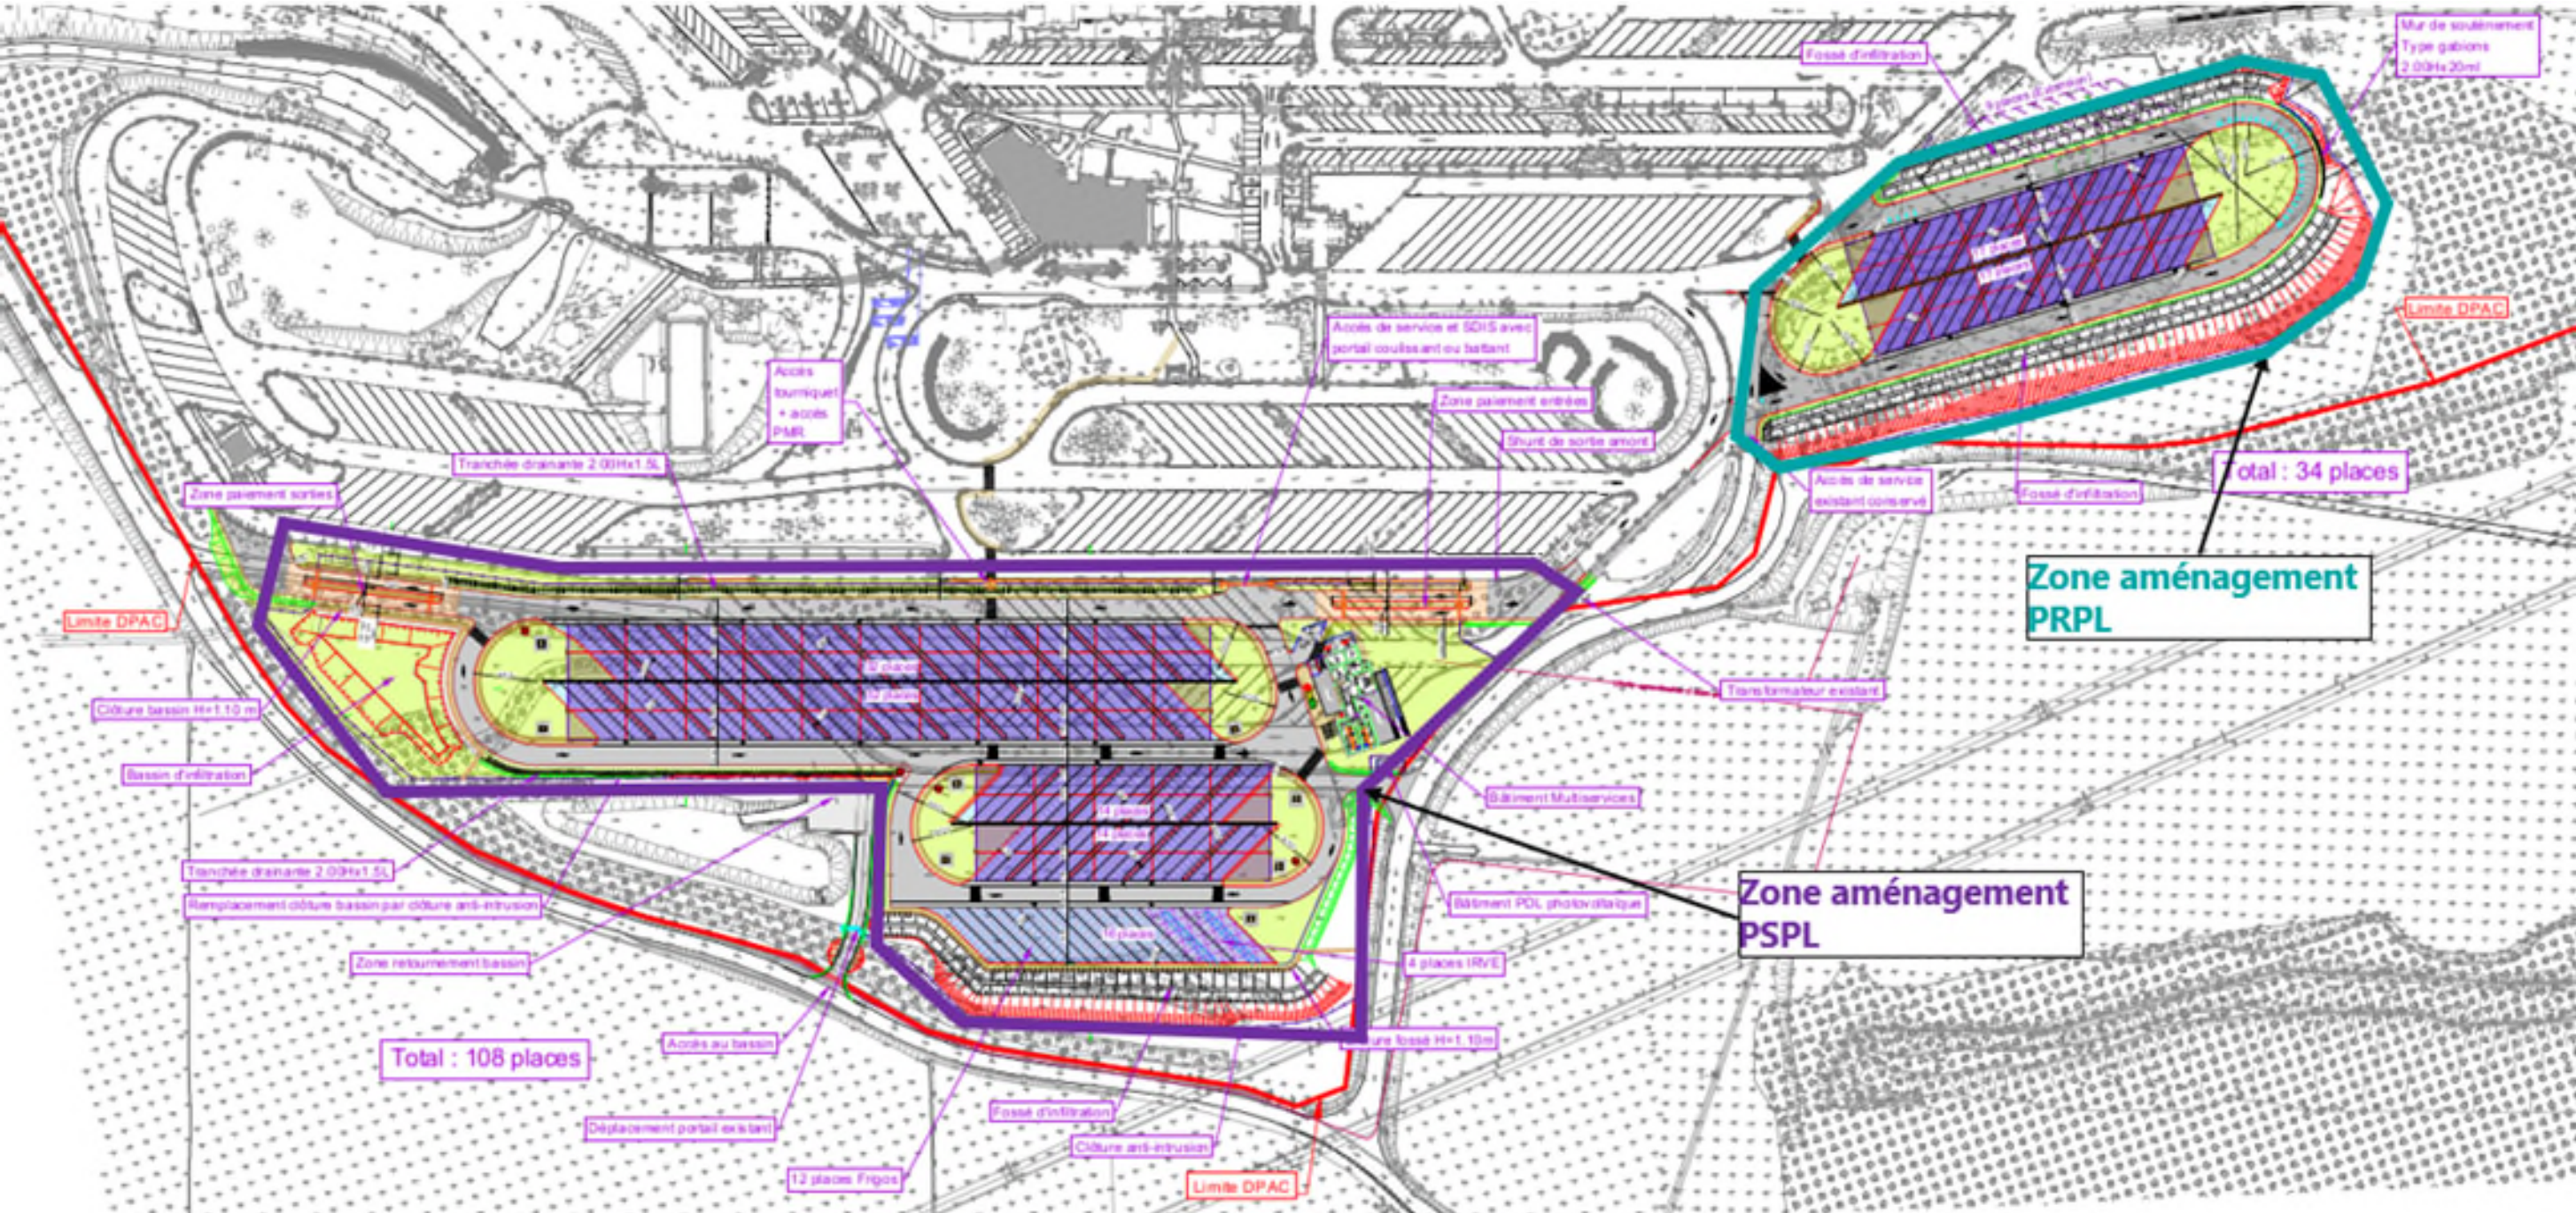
PLAN GÉNÉRAL DE LA SOLUTION PROPOSÉE
